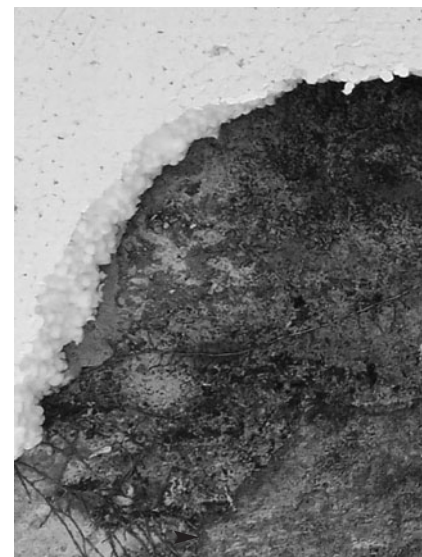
Algenbefall unter der Däm-mung aus Styropor; Quelle: bauwerk.architekten, Dresden
